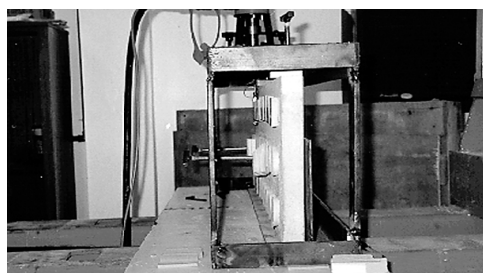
Substrato fixado ao suporte, pronto para o ensaio
